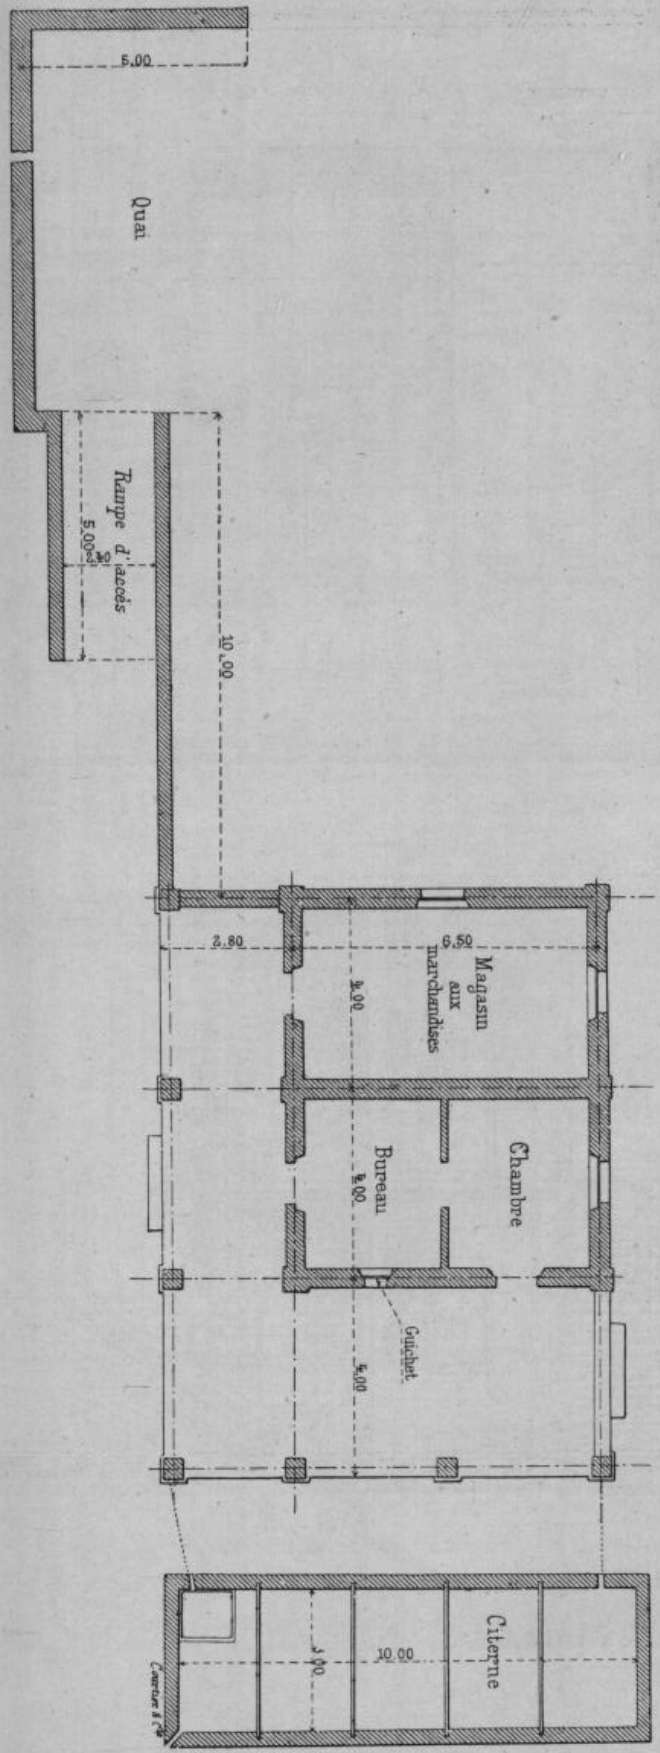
PLAN DE LA GARE D'ABIDJAN-VILLE.
